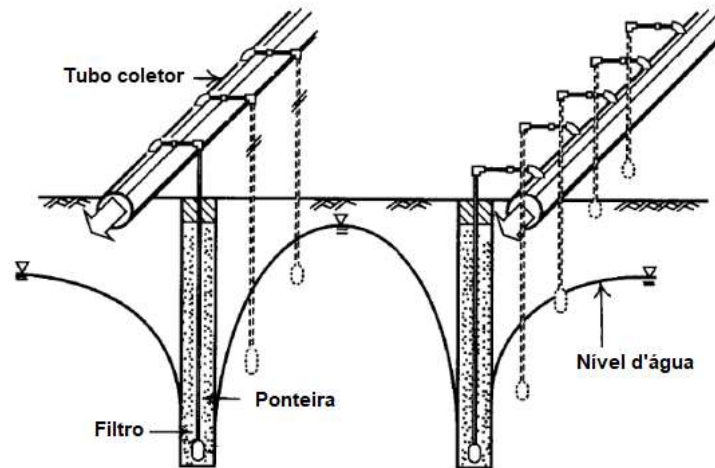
Sistema de rebaixamento de água por ponteiros (Ou, 2006)
